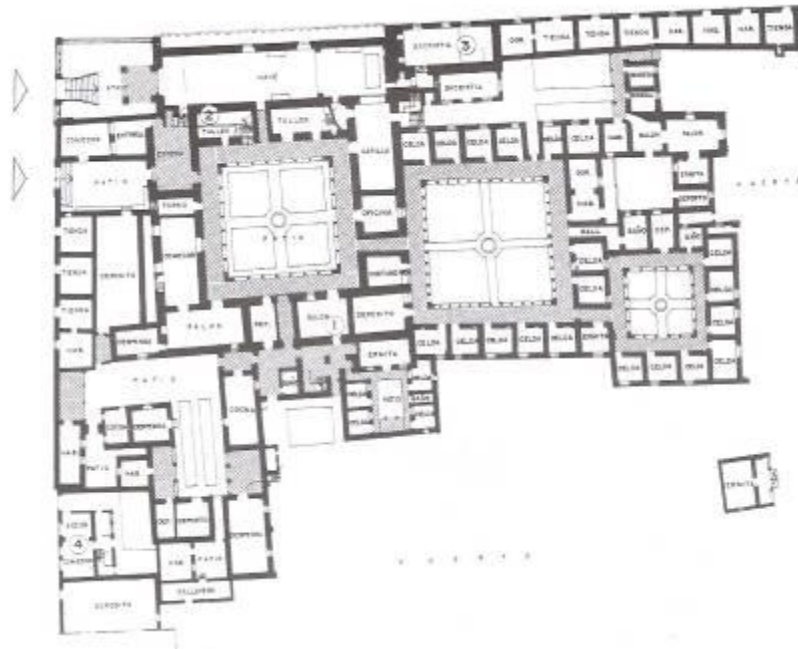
Planta muy compartimentada. Convento de Santa Teresa
